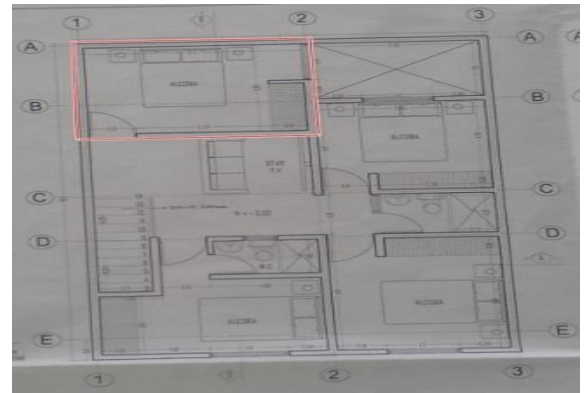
Diseño arquitectónico aprobado por curaduría, fuente propia
